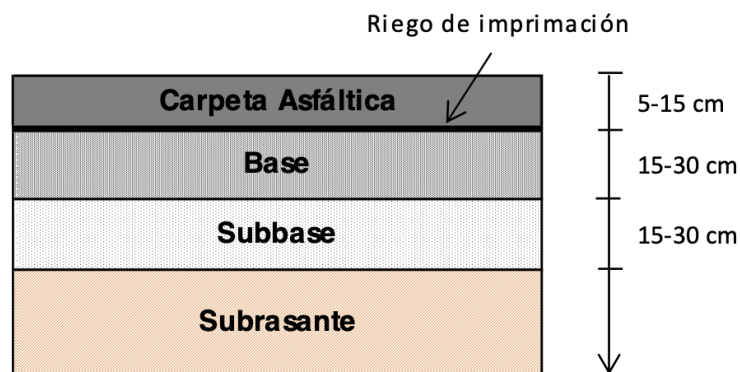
Sección típica de pavimento flexible. Fuente: Andrade Triviño y Franco Puga (2019).
